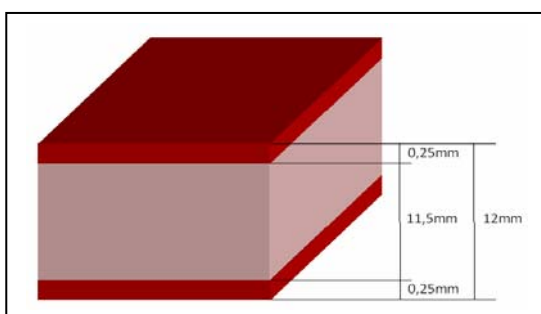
Espessuras da matriz e reforço do painel de GRC (Glass Reinforced Cement).
